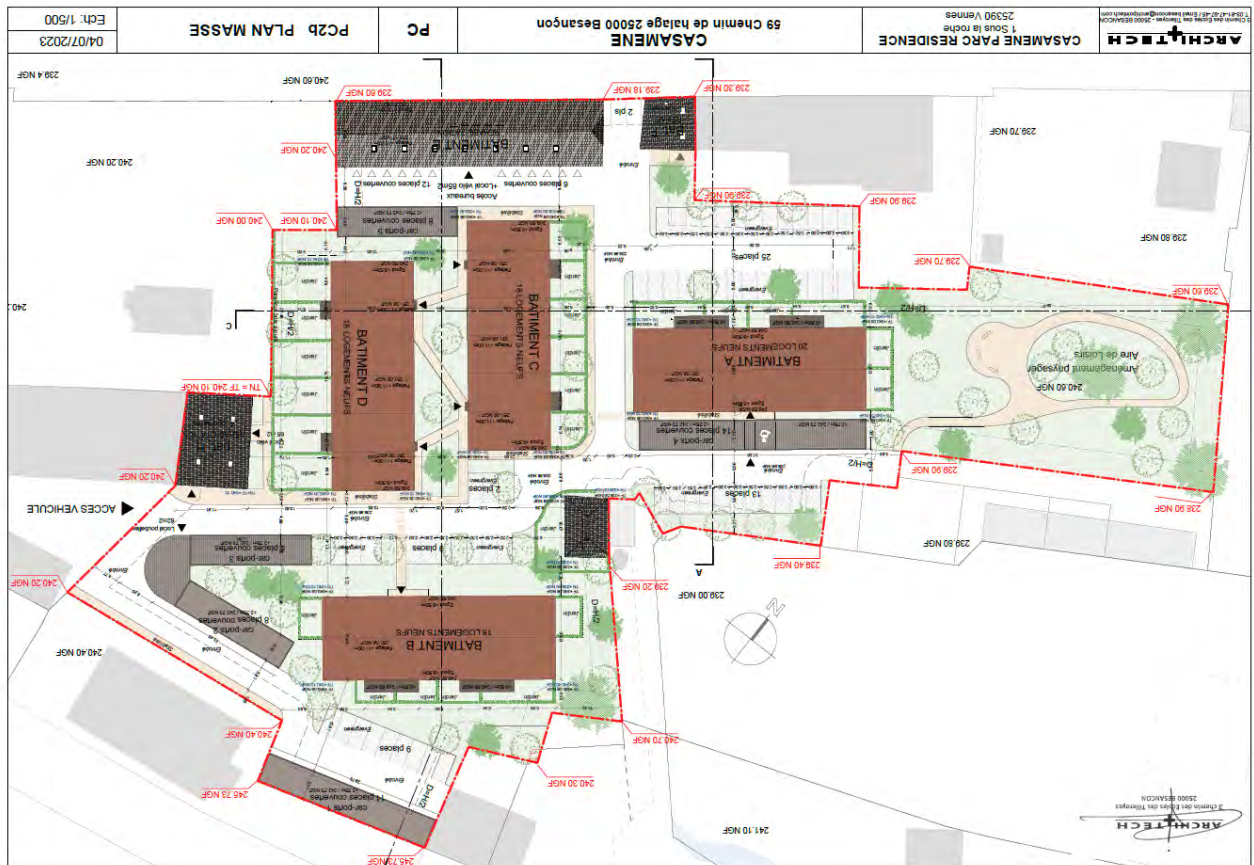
Plan d'implantation des bâtiments (documents architecte)
